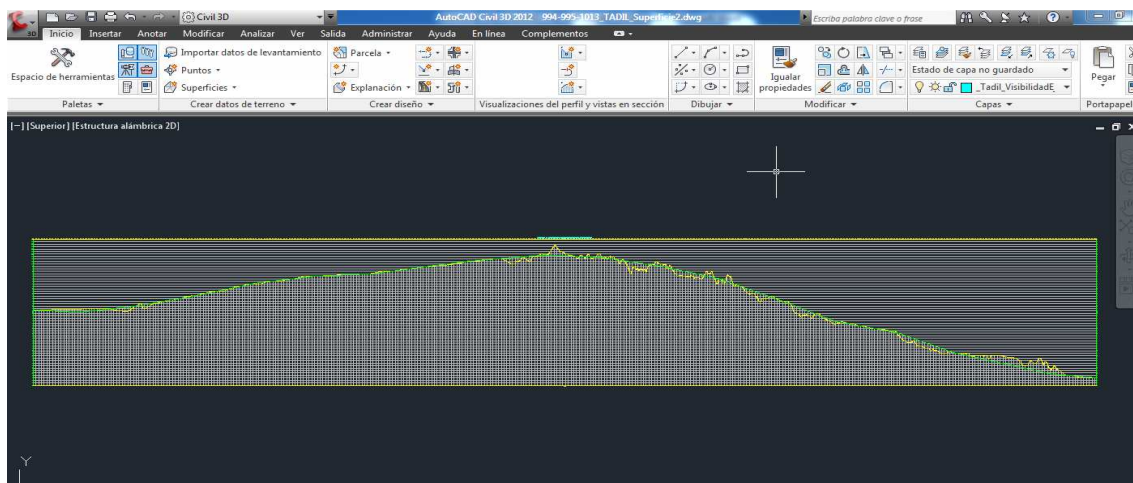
Profil longitudinal de l'enveloppe minimum avec avancées longues
